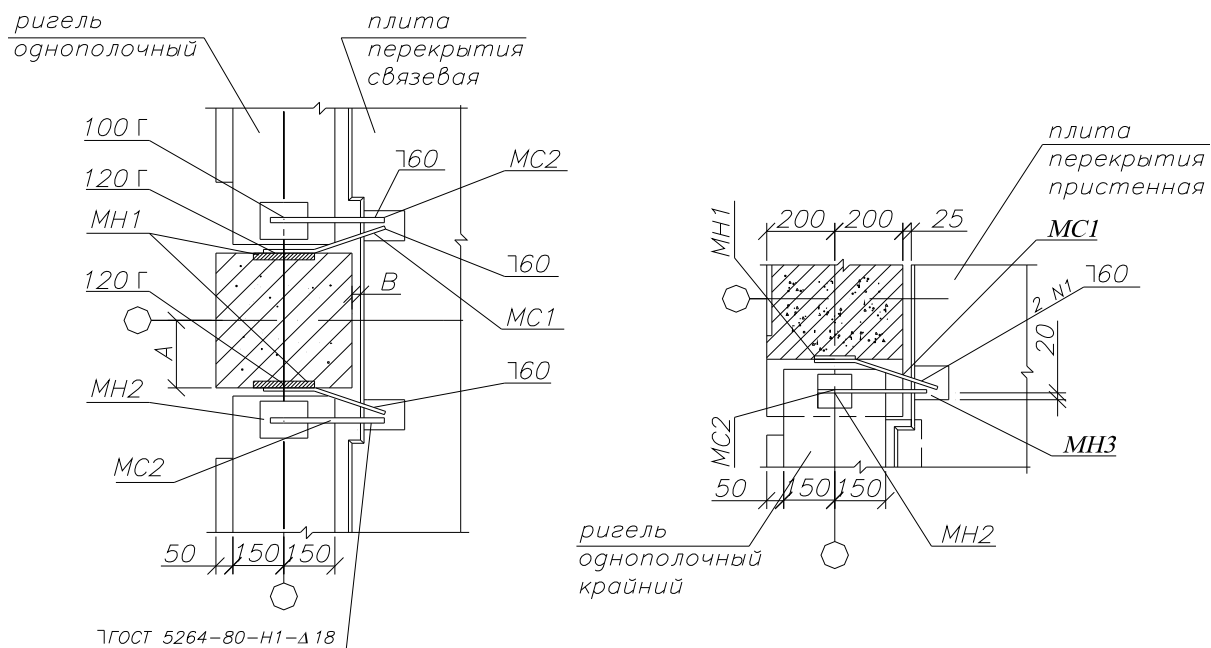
Крепление плит перекрытия к ригелям и колонне крайнего ряда:
